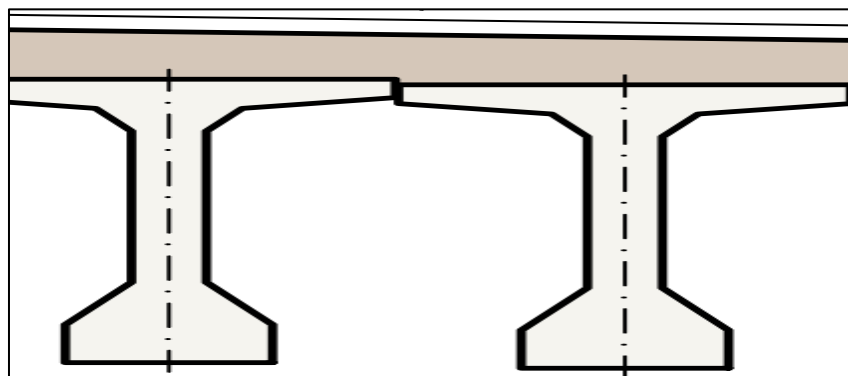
1 Coupe schématique d'un tablier à poutrelles précontraintes par pré tension
